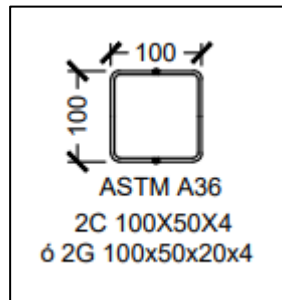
Sección viga longitudinal (Segura, A. & Vélez, F., 2020)
